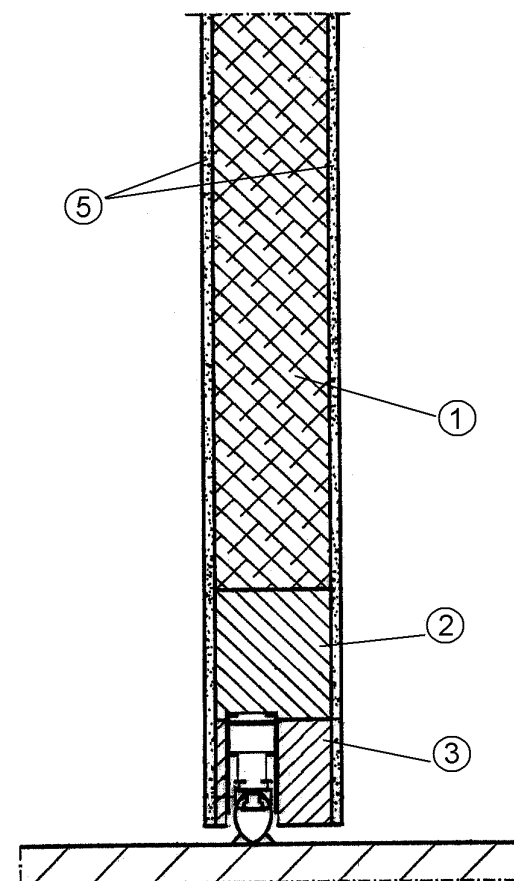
Détail joint d'étanchéité Schall-Ex RD 2
